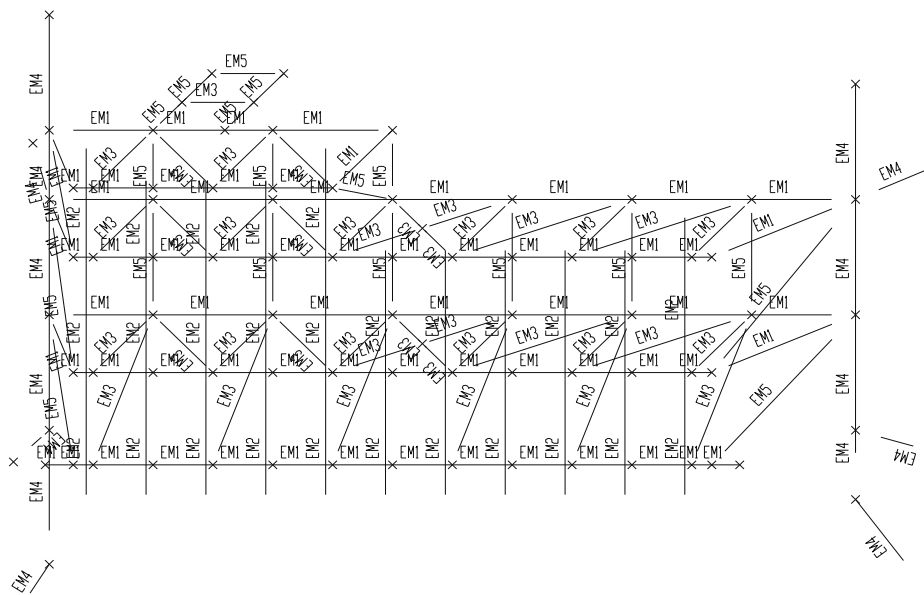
Planta cubierta principal elev (+) 19.100 m.
